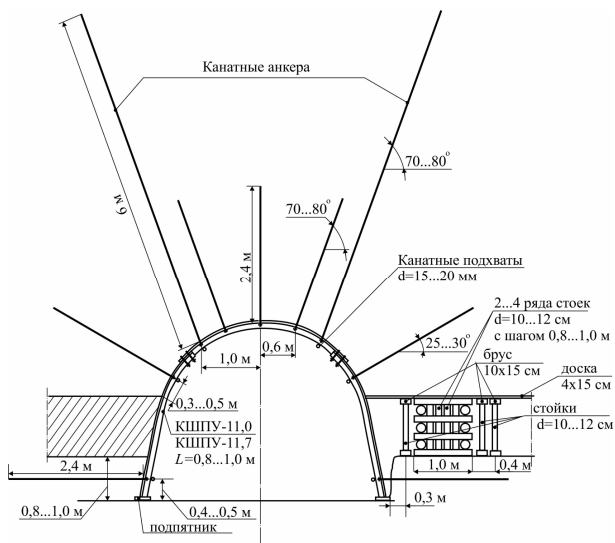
Схема поддержания выработки при возведении охранной системы из лесоматериалов
